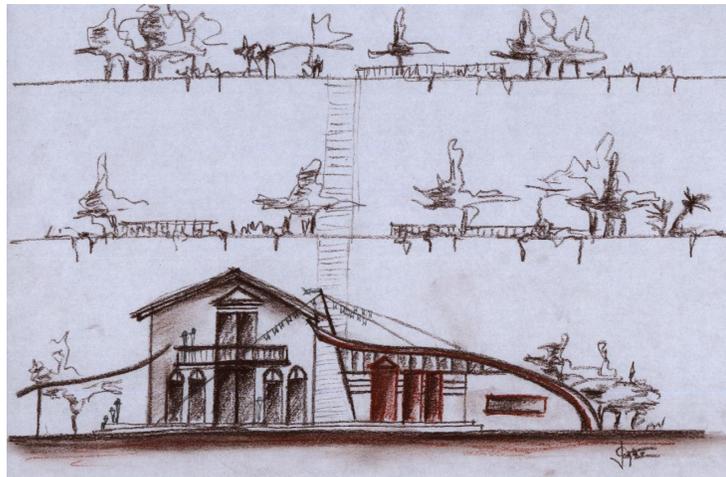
Proposta de composição entre Construção Tradicional e Contemporânea, composta por elemento de acesso aos platôs e cume por esteira rolante ou teleférico.
